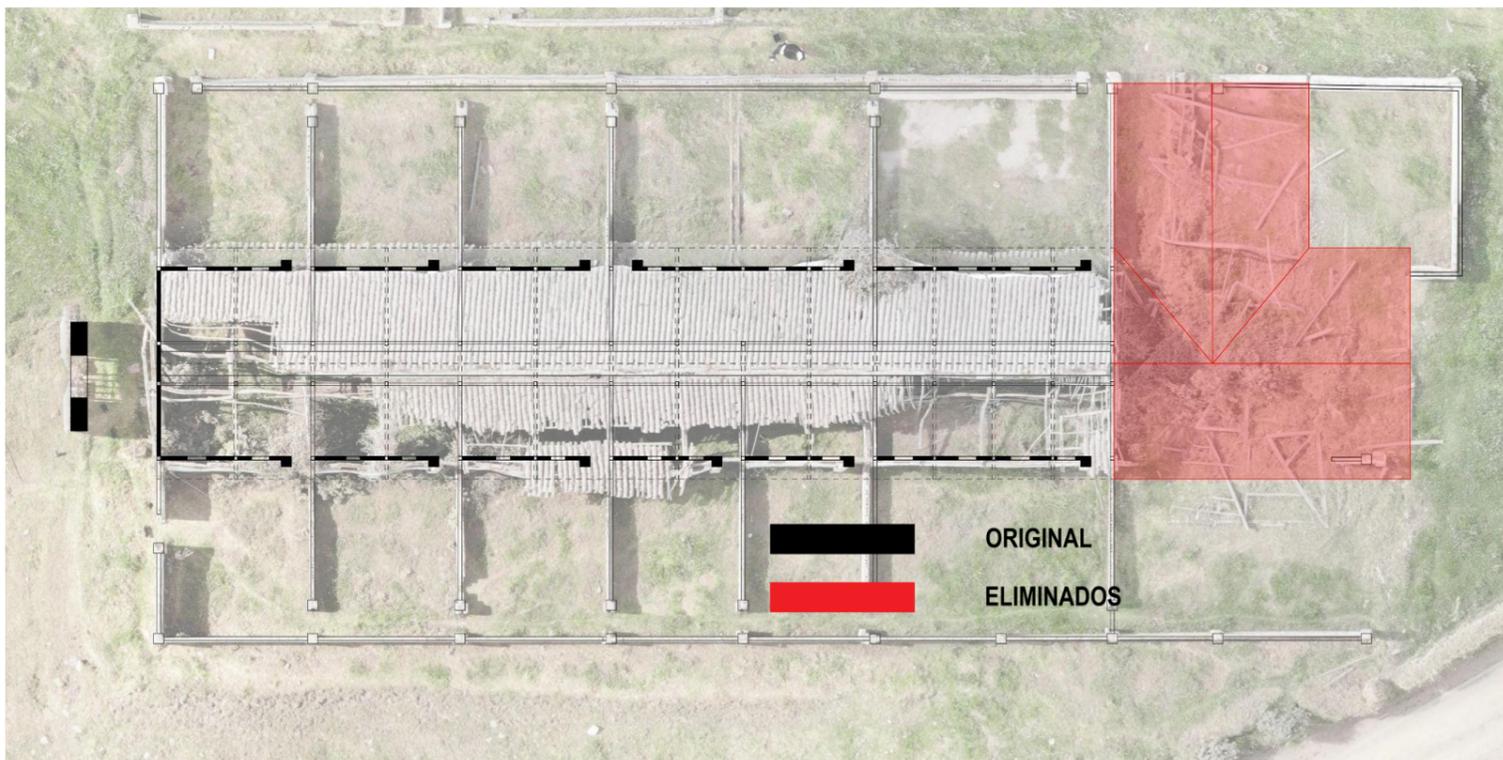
Planta Bloque 11 Elementos eliminados Fuente Luis Segovia 2023
